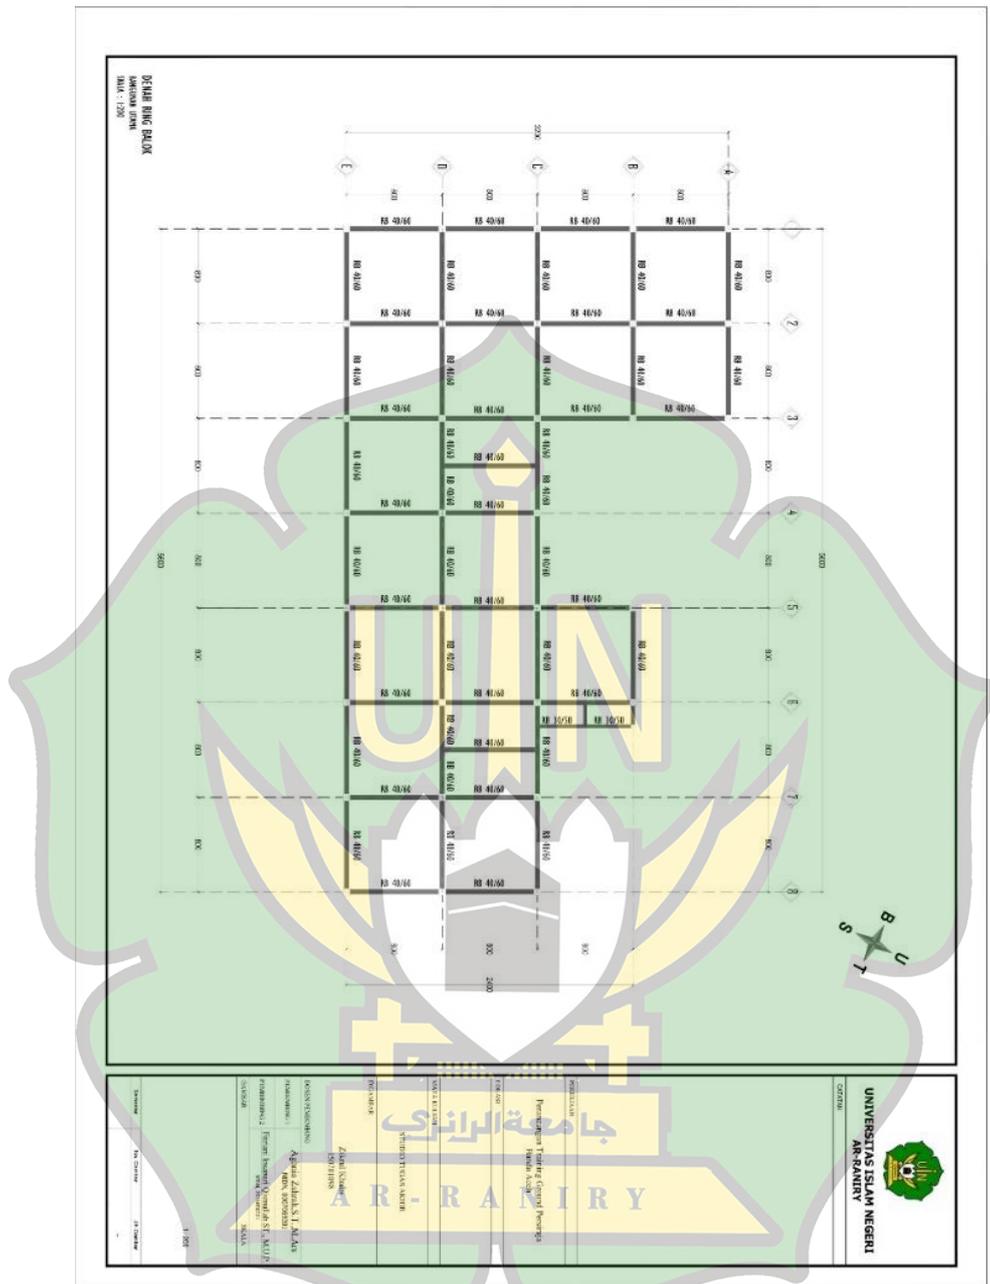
Denah Rencana Balok Lantai Lt 1 bangunan Utama
